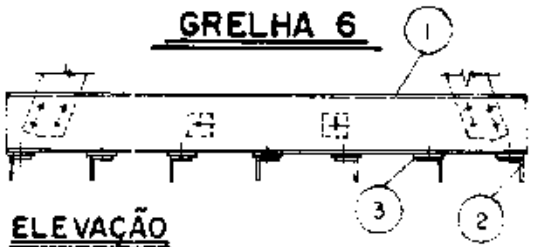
a - CONFIGURAÇÃO ESTRUTURAL DAS GRELHAS
